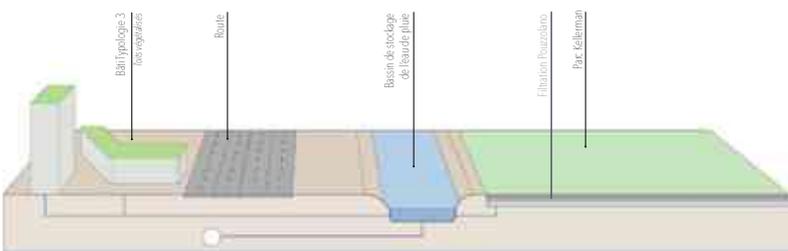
Dessins personnels, intervention sur le Parc Kellermann, coupe schématique plan
